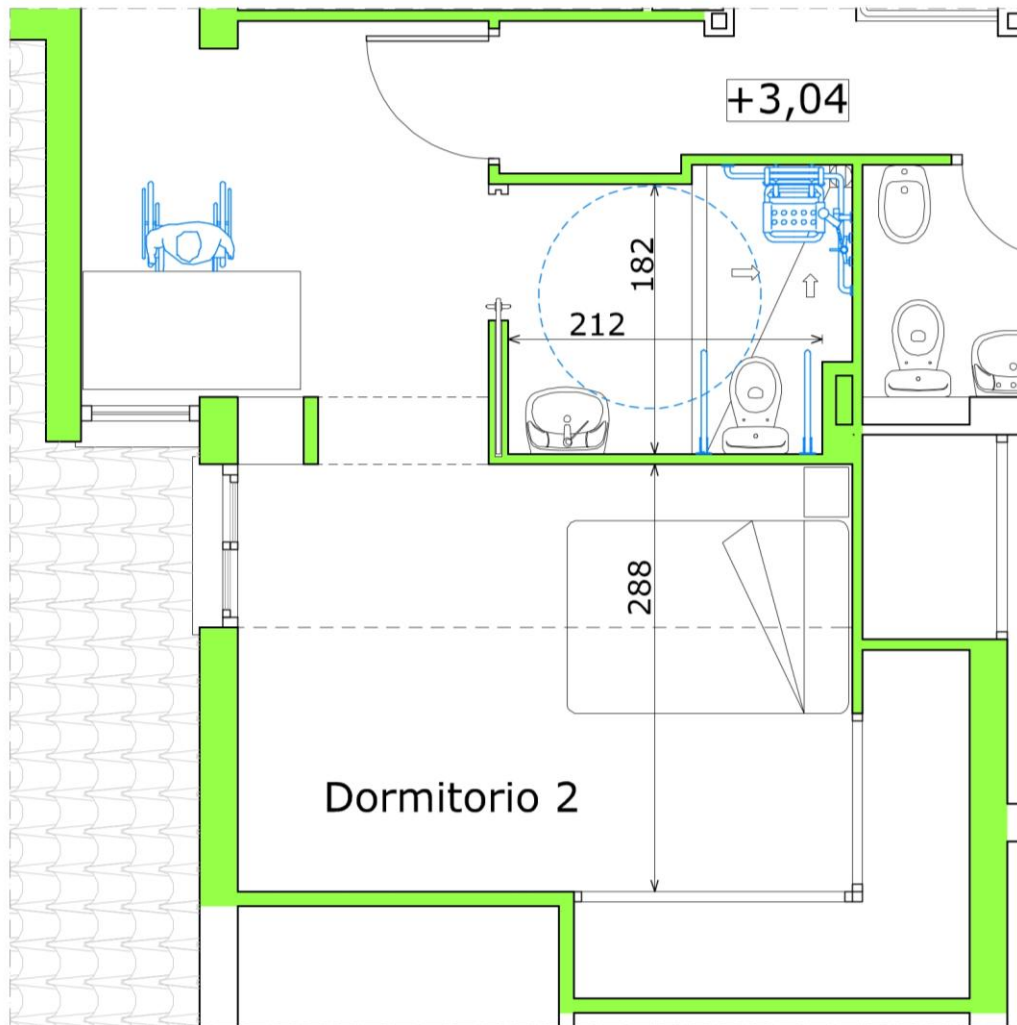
Plano detalle habitación planta primera, acceso al cuarto de baño desde la zona de trabajo.
